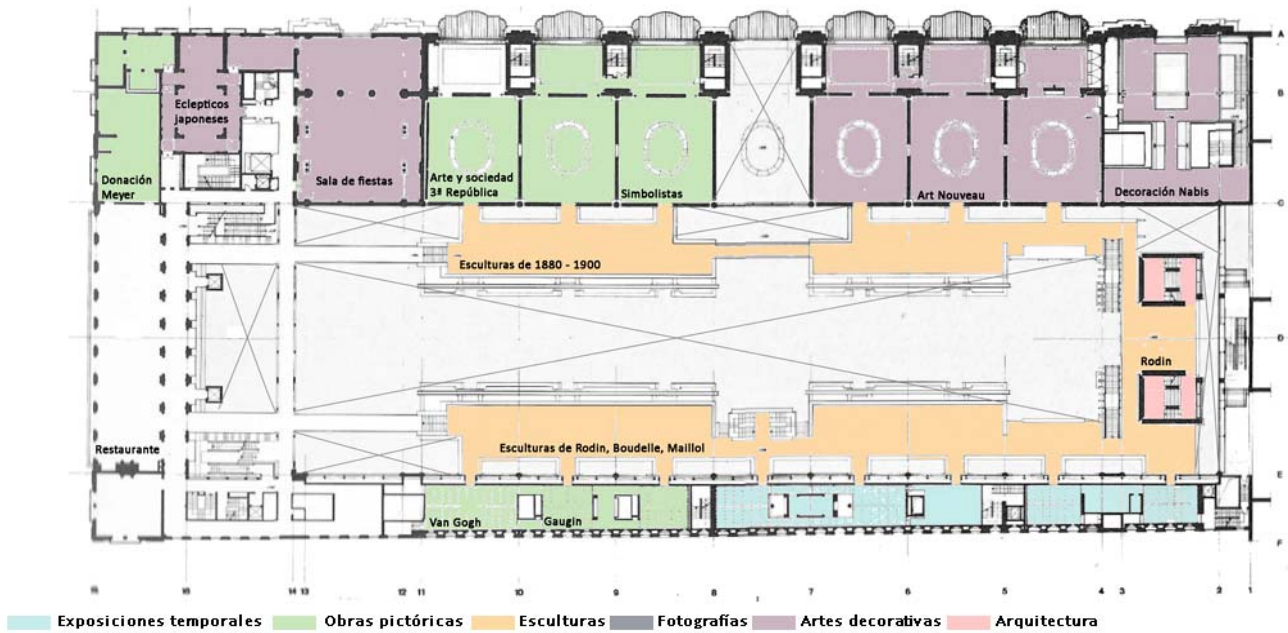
Planta primera con clasificación de salas según tipo de obras (Anexo 1)
